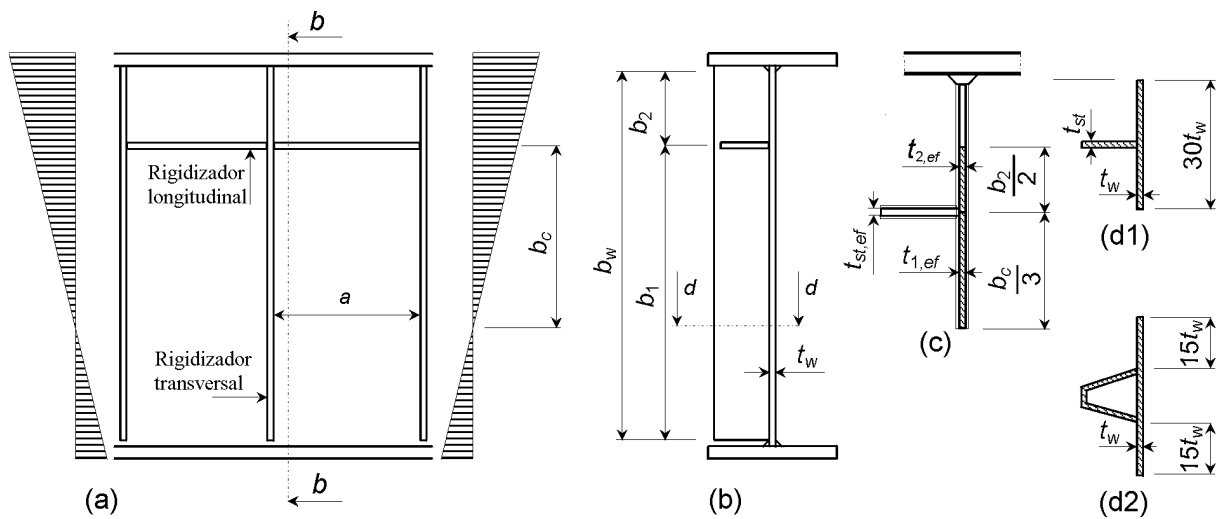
(a) Alma rigidizada (b) sección transversal (c) área eficaz de columna ficticia (d) sección transversal de la columna ficticia para cálculos de I_{st} (d1) rigidizador abierto (d2) rigidizador cerrado
